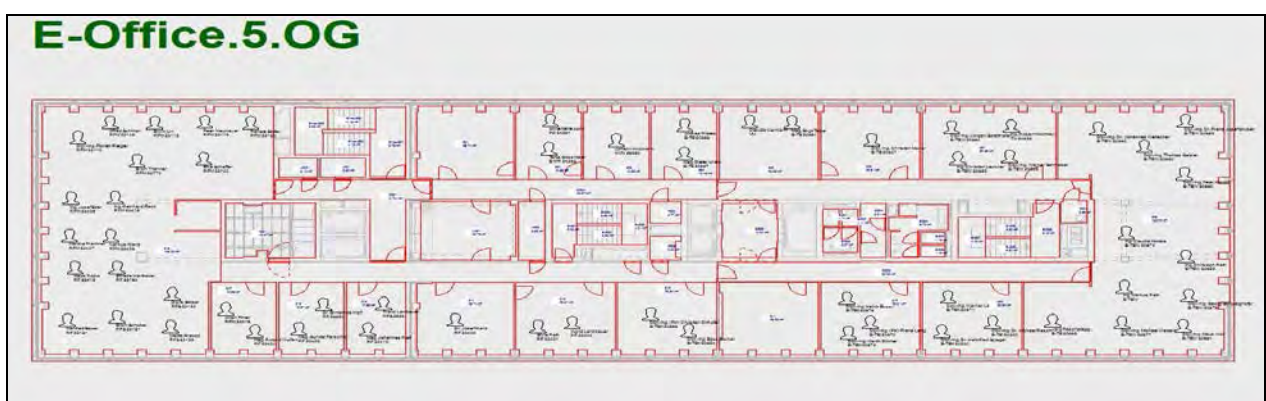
Grundriss Energie Steiermark 5. Obergeschoss
